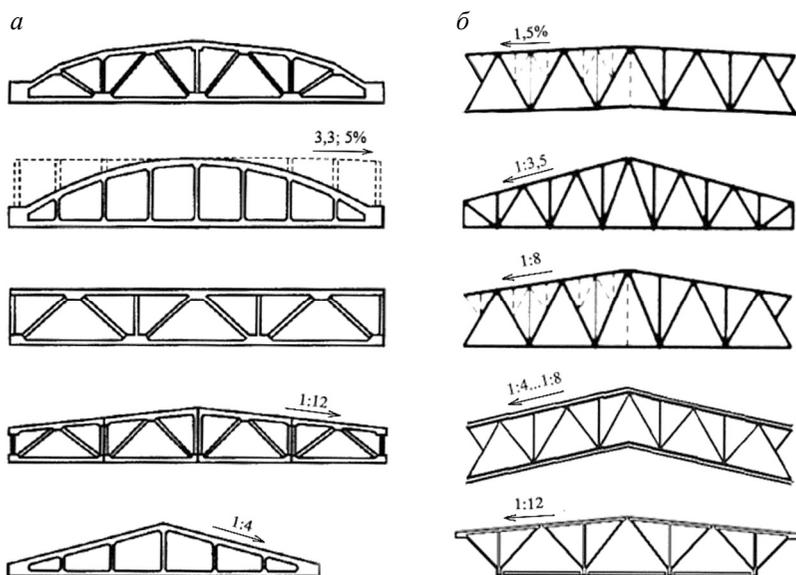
Типы стропильных ферм: *a* — железобетонные (сегментные, безраскосные (пунктиром конструкция под малоуклонную кровлю), с параллельными поясами, полигональные, треугольные); *б* — металлические
